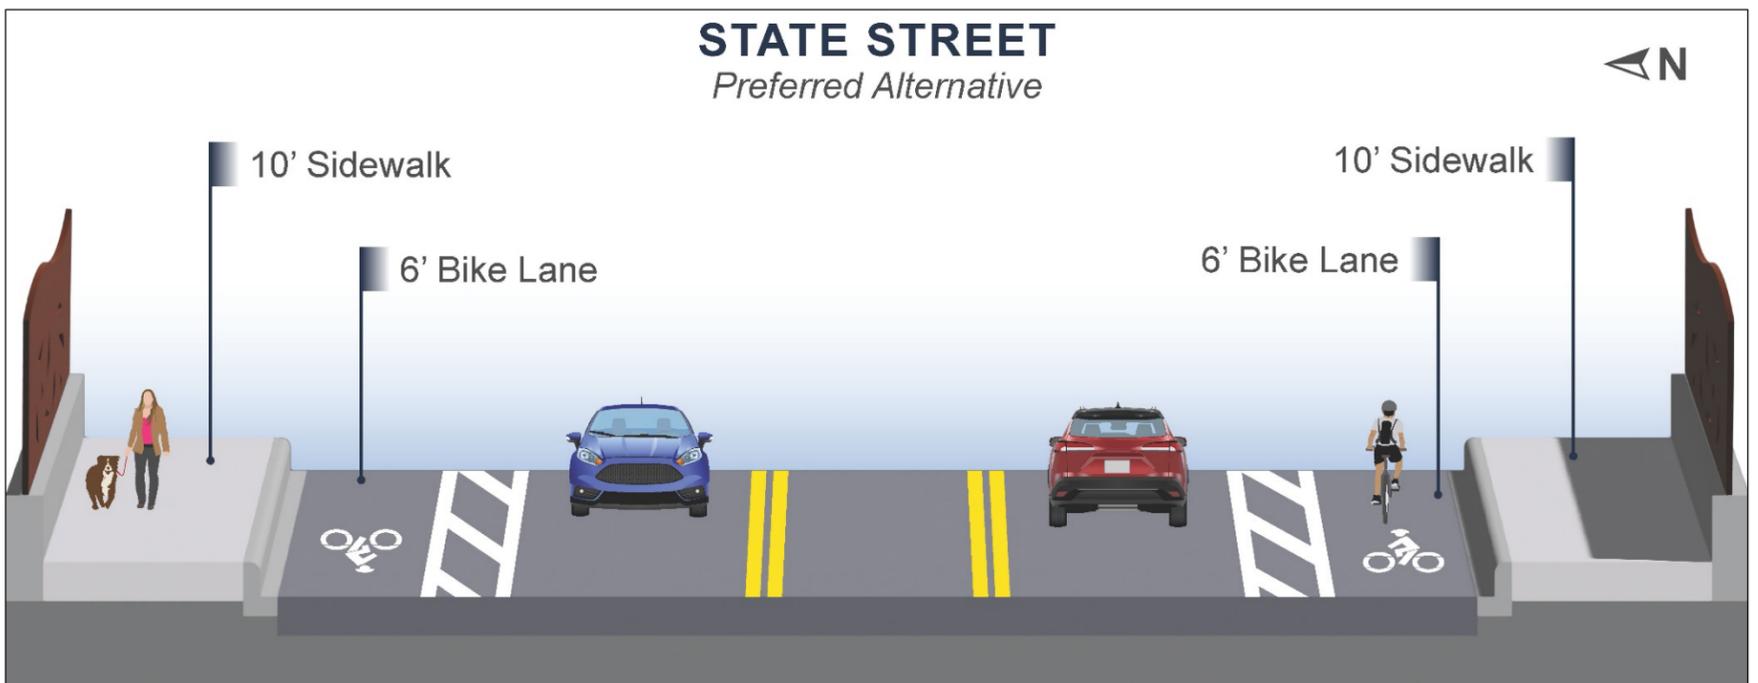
Alternativa de Acción: tramo de Centerville
